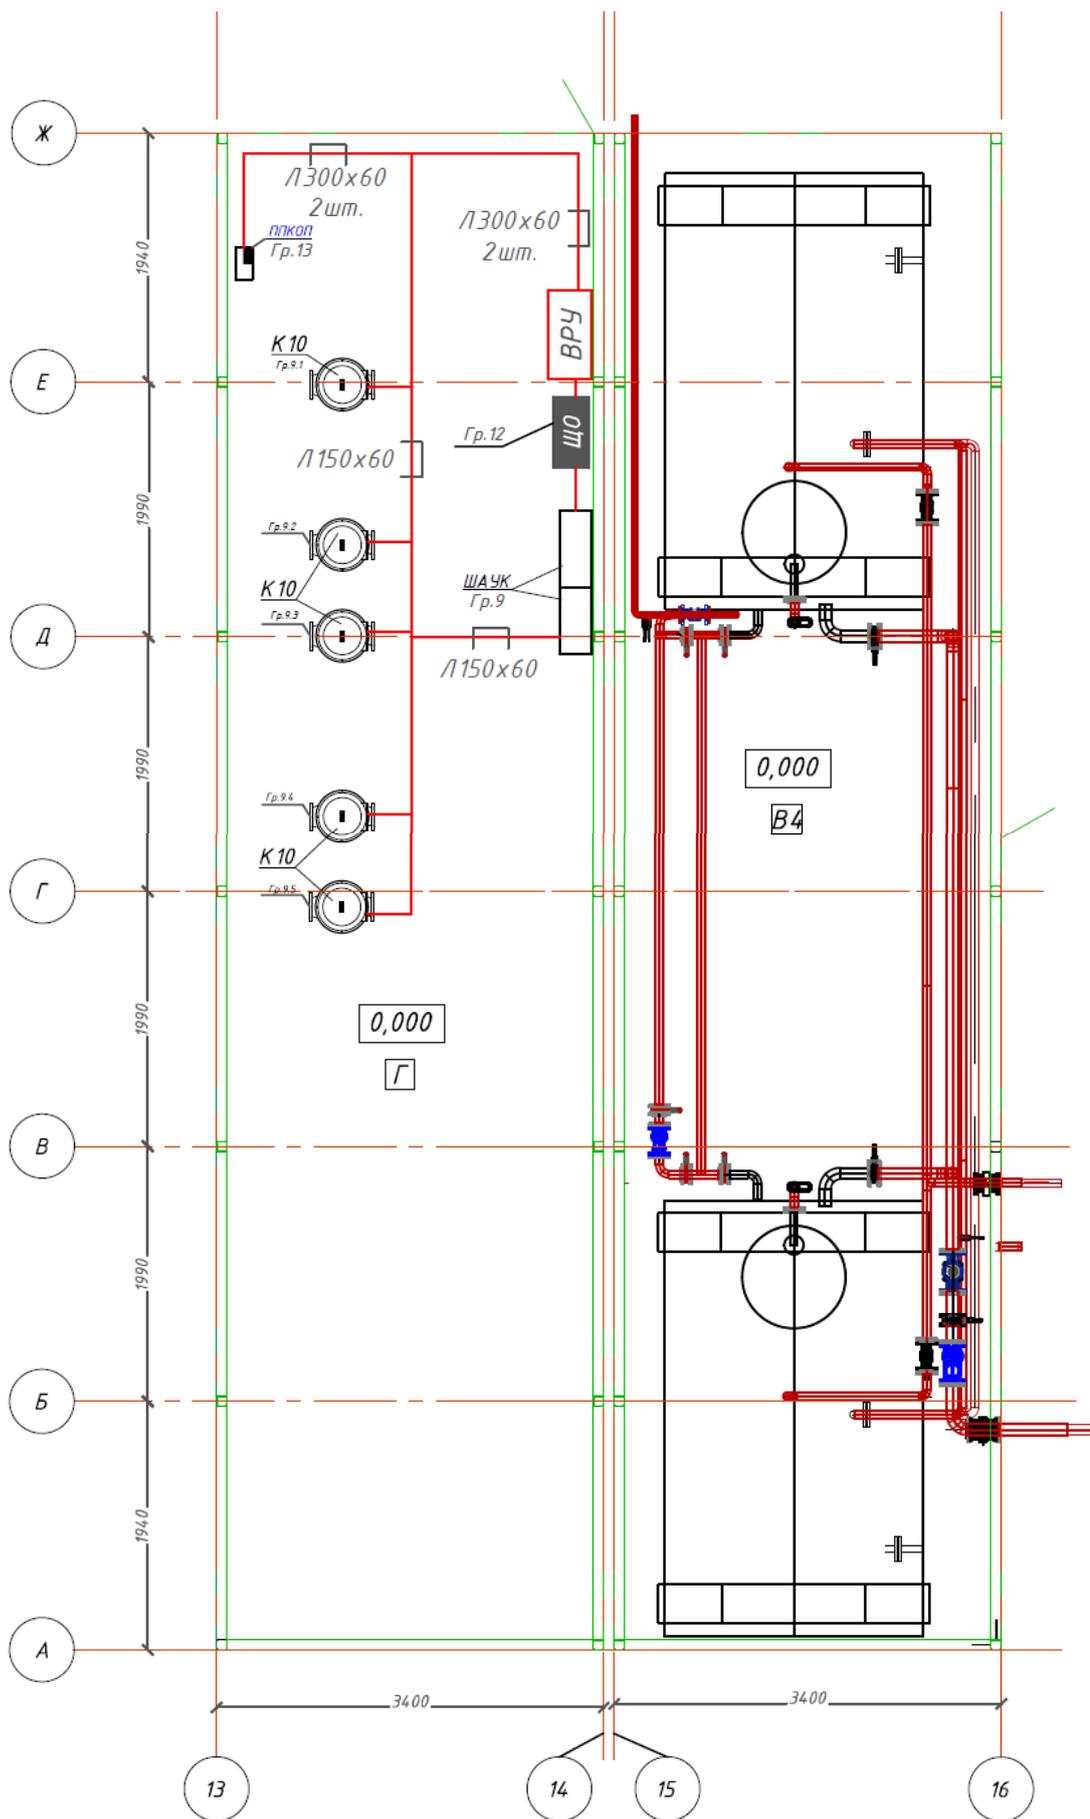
План прокладки распределительной сети блока №5 котельной
